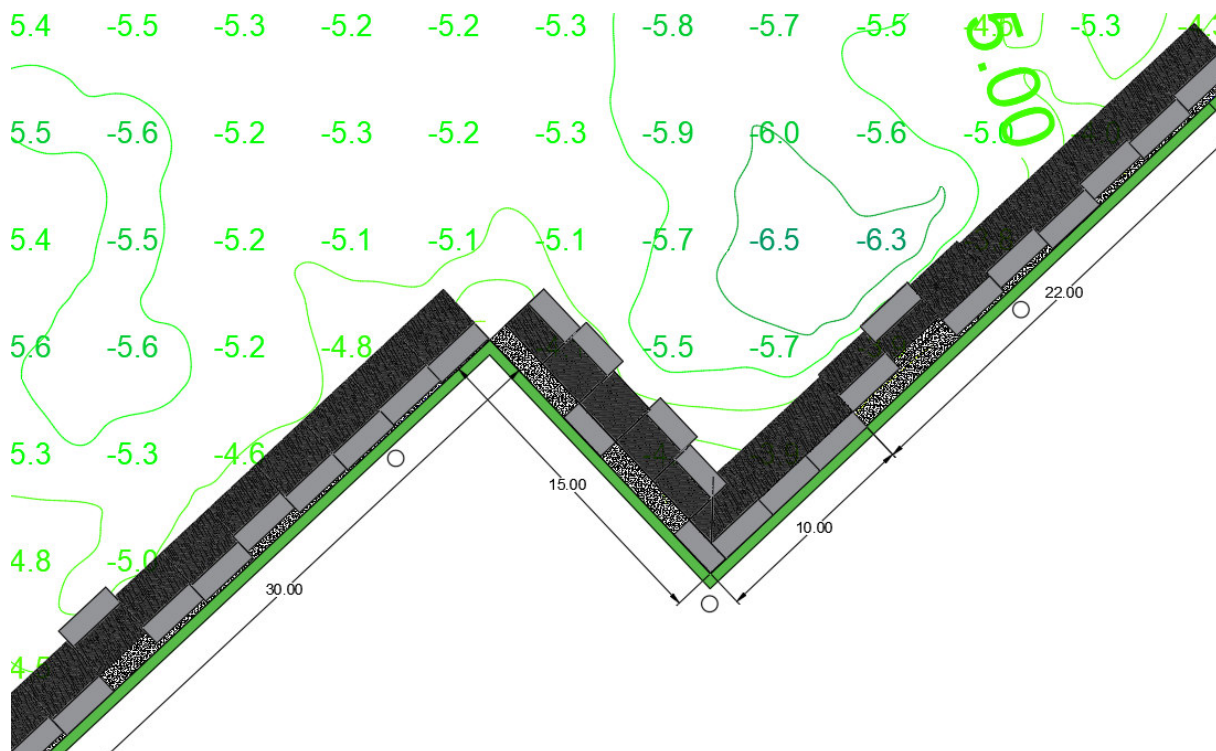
Estado actual (desplazamiento de bloques y batimetría)
